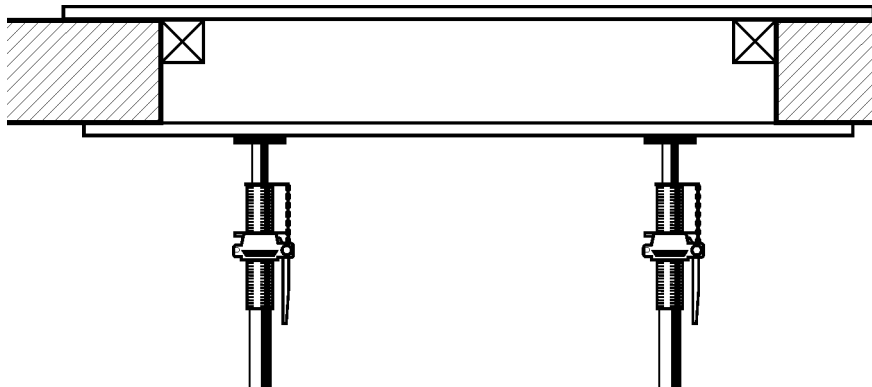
Recouvrement des découpes de sol ou de plafond
